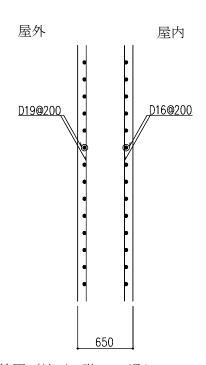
耐震壁の配筋図(地下1階, YH通り X17~X18 通り間)(単位:mm)
